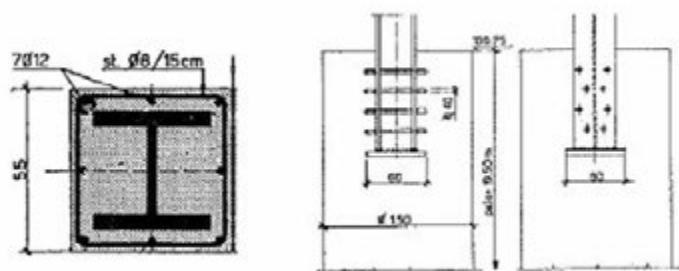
| Sezione colonna rivestita e ancoraggio della colonna al palo di fondazione
